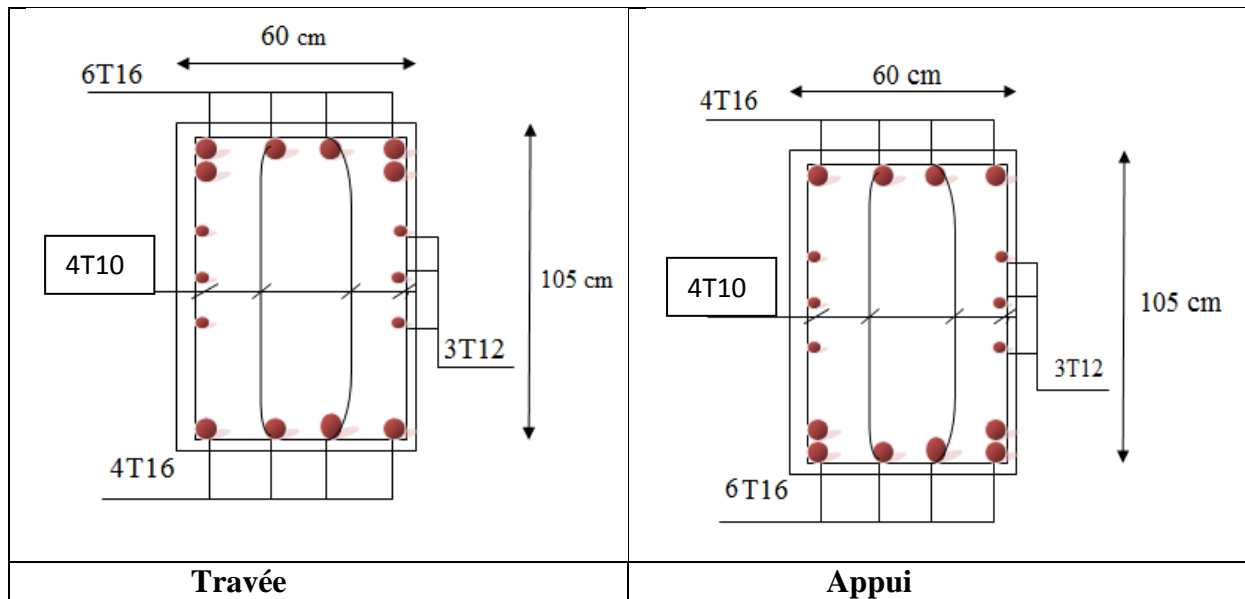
Ferrailage des nervures pour sens longitudinale.
